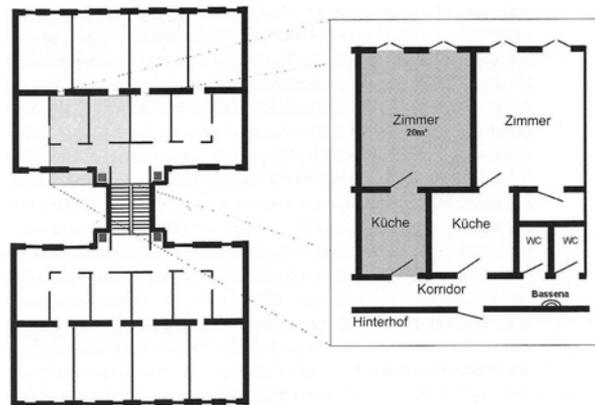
Grundrissplan eines typischen Arbeitermiethauses aus der Gründerzeit (2. Hälfte des 19. Jahrhunderts)
